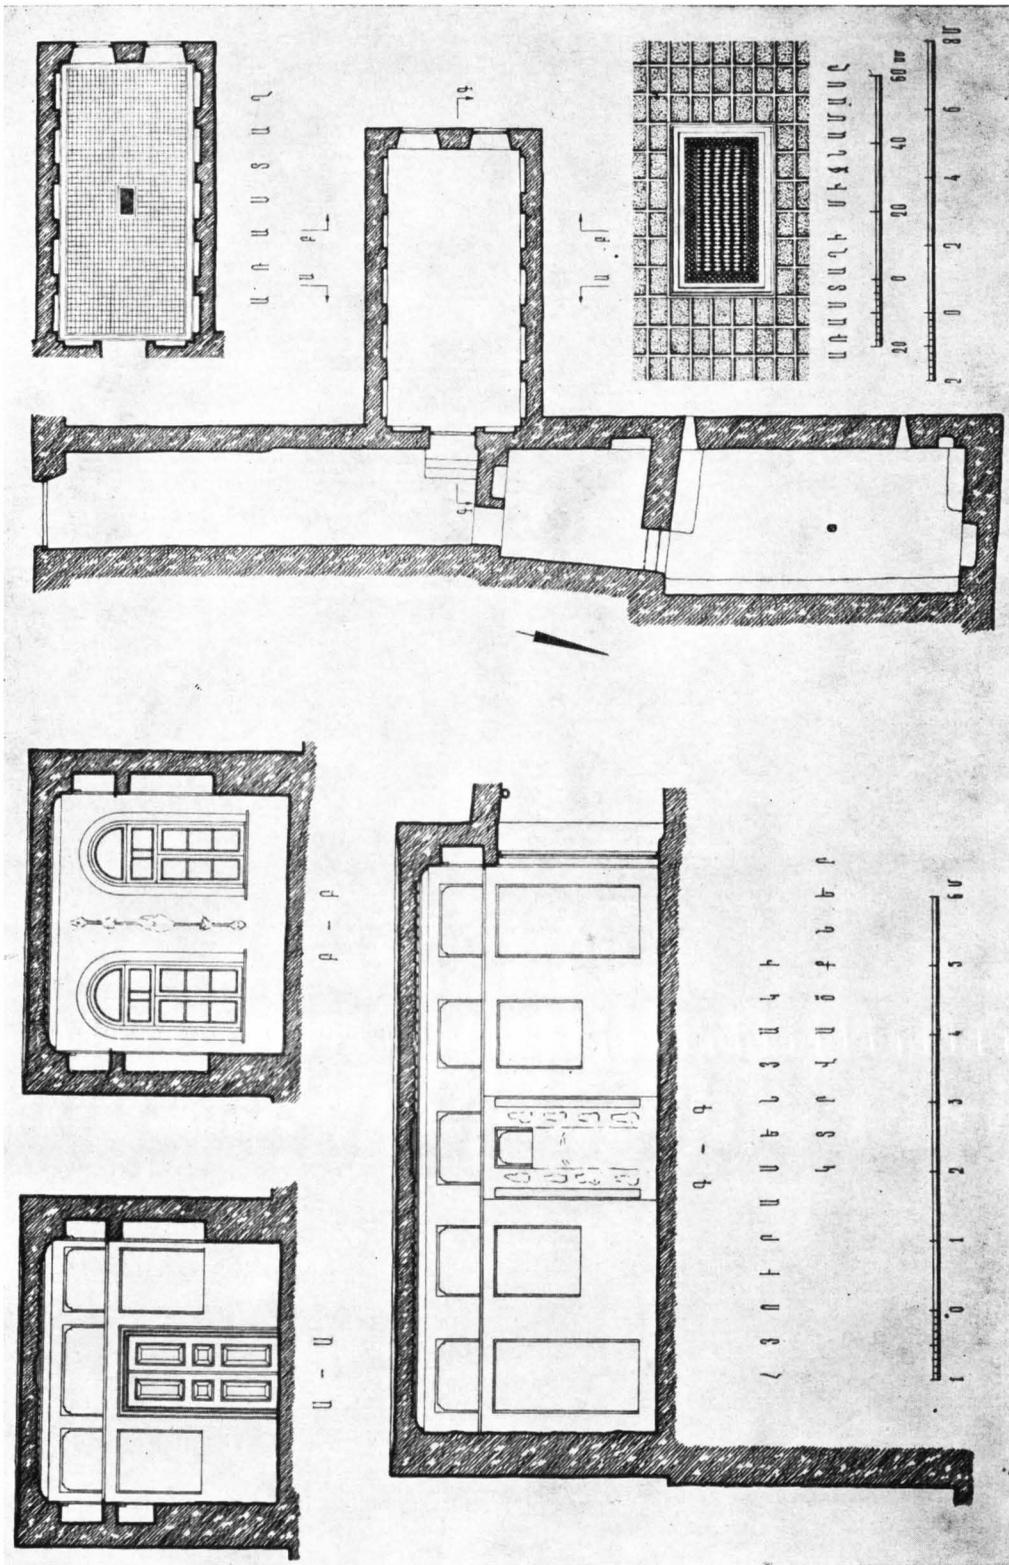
Maison de type ancien avec salon de Meghri (coupes, plan, plafond et fragment du plafond).
